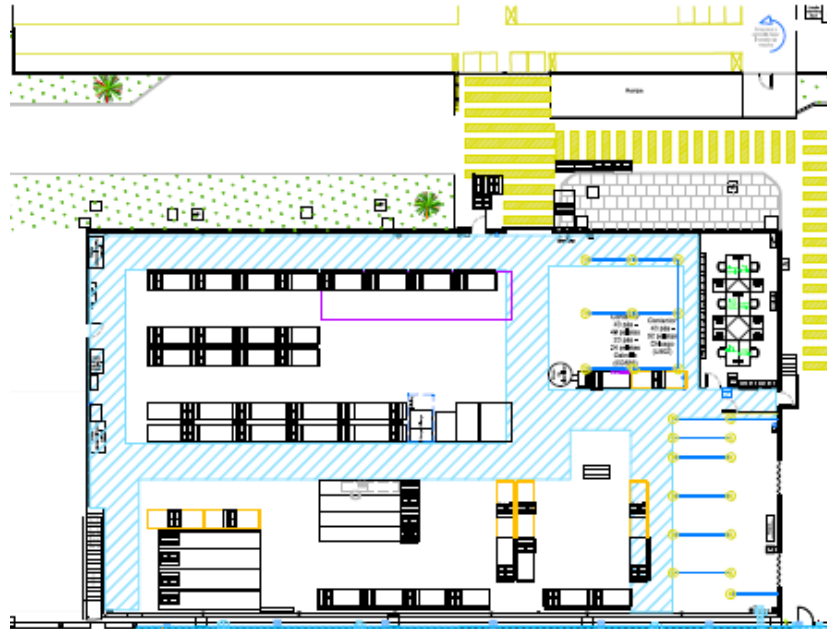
Layout Inicial do Armazém do Departamento da Expedição
